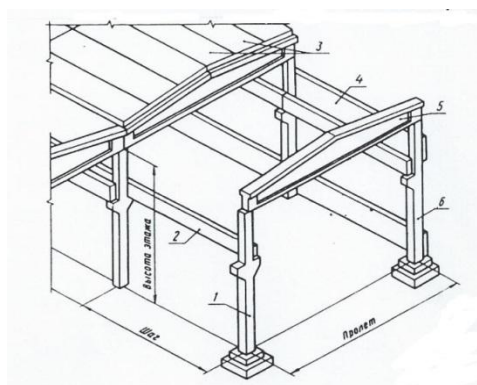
Конструктивные элементы каркасного здания: 1-средняя колонна, 2-подкрановая балка, 3-плиты перекрытия, 4-стенная панель, 5- подстропильная балка, 6-пристенная колонна.
